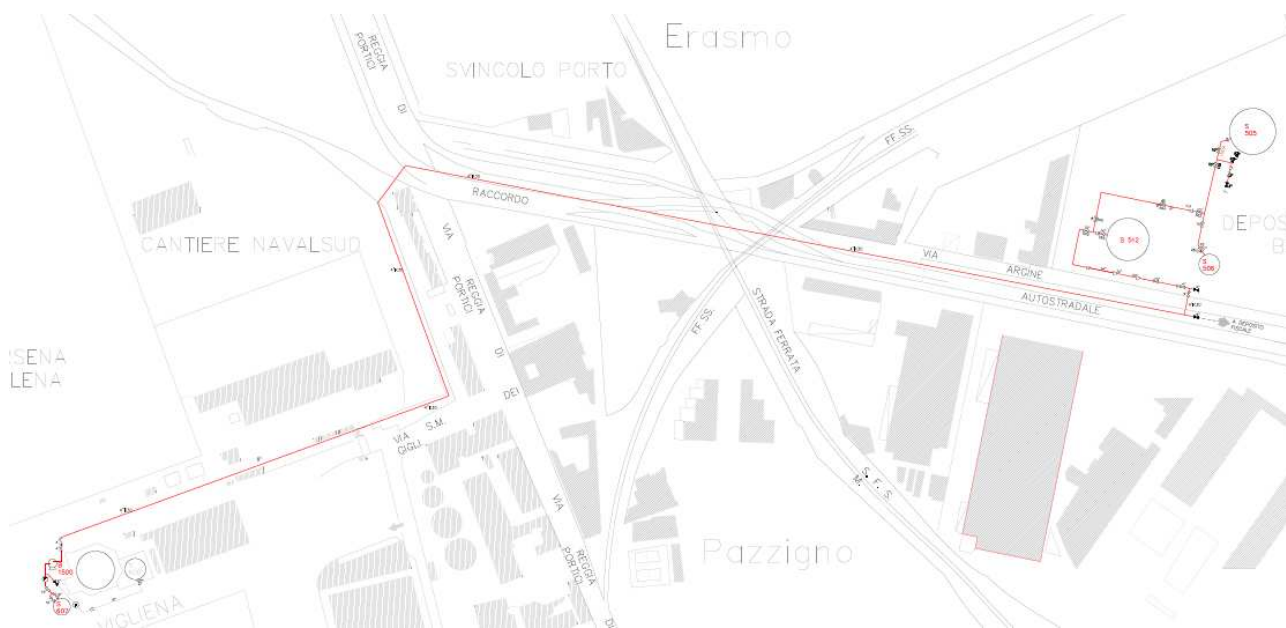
Stralcio planimetria con individuazione Piping di collegamento ai serbatoi S-505, S-506 e S-512
